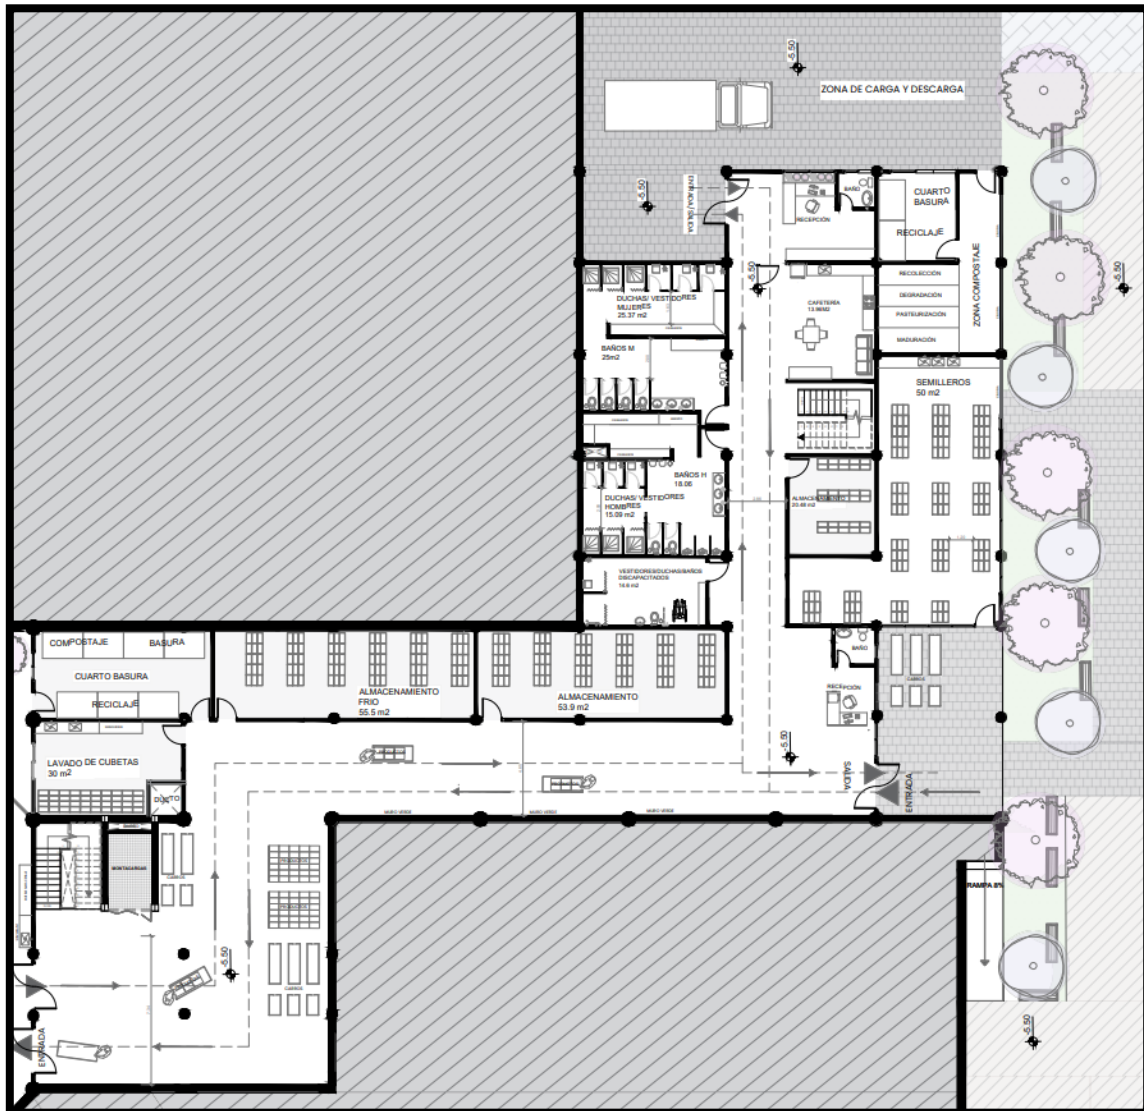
Planta Nivel -5.50 Ramires S 2023
